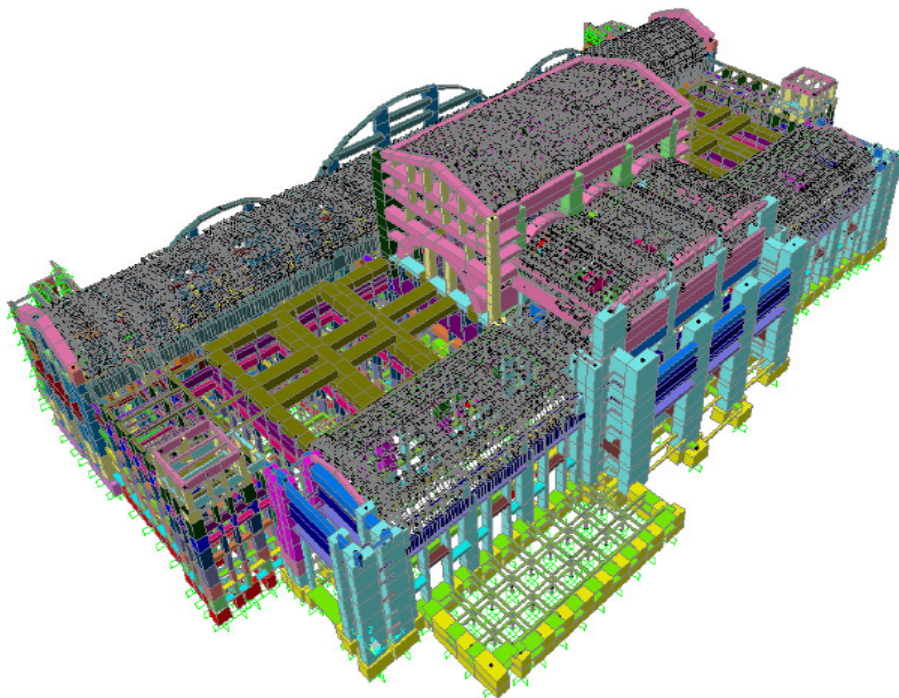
Vista del modello a telaio spaziale della struttura della Stazione Centrale
